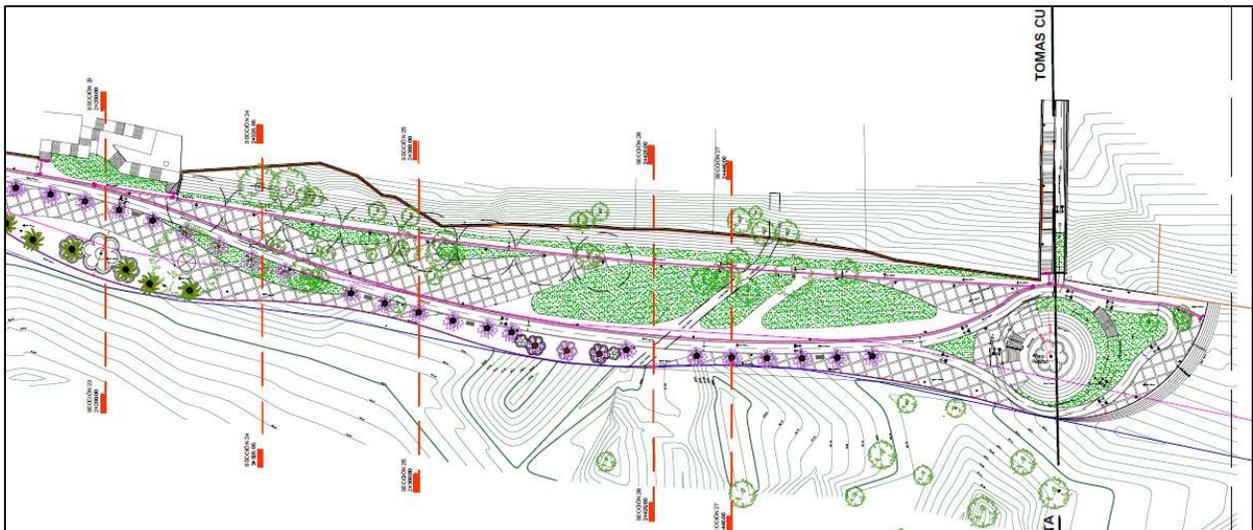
Planta arquitectónica Sección 3 del proyecto
